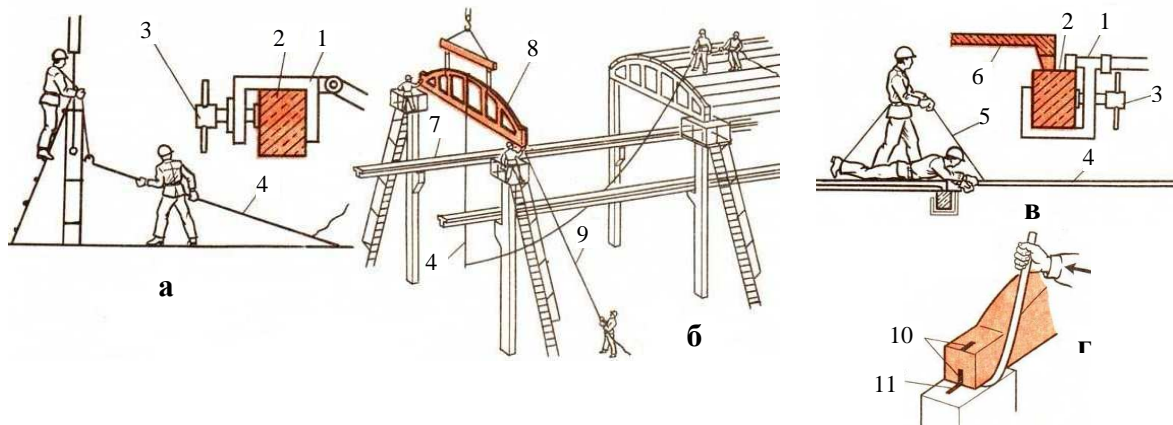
Схема монтажу крокової ферми: а – прикріплення тимчасової розпірки до ферми; б – розташування монтажників під час установлення ферми; в – укріплення встановленої ферми фіксувальною розпіркою; г – суміщення відміток ферми і колони; 1 – струбцина; 2 – верхній пояс ферми; 3 – притискний гвинт; 4 – розпірка; 5 – канат для піднімання розпірки; 6 – плита покриття; 7 – підкранова балка; 8 – ферма; 9 – відтяжка; 10 – відмітка на фермі; 11 – відмітка на колоні
